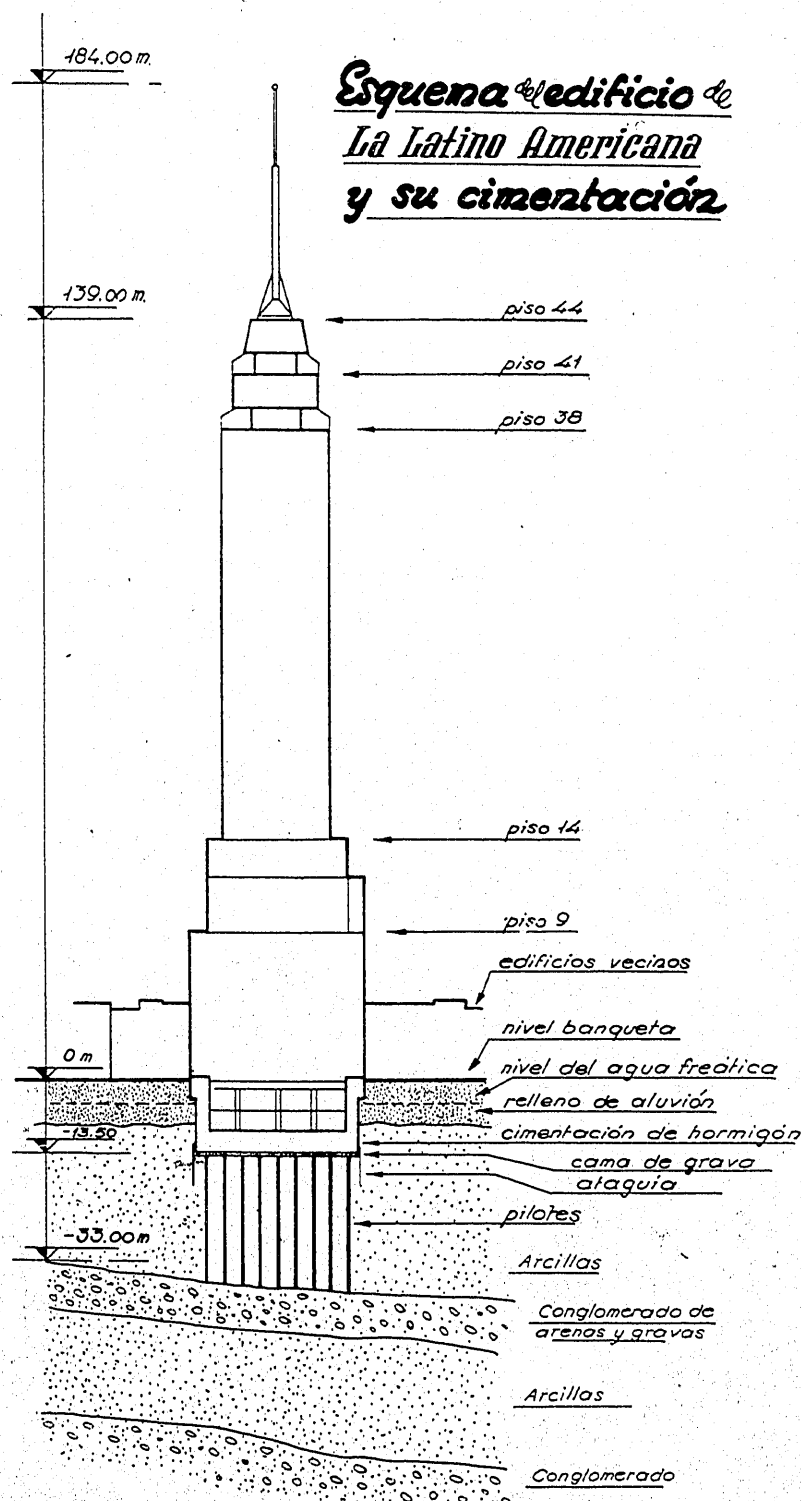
^a. — Esquema del alzado y cimentación del edificio de la "Latino-Americana".
